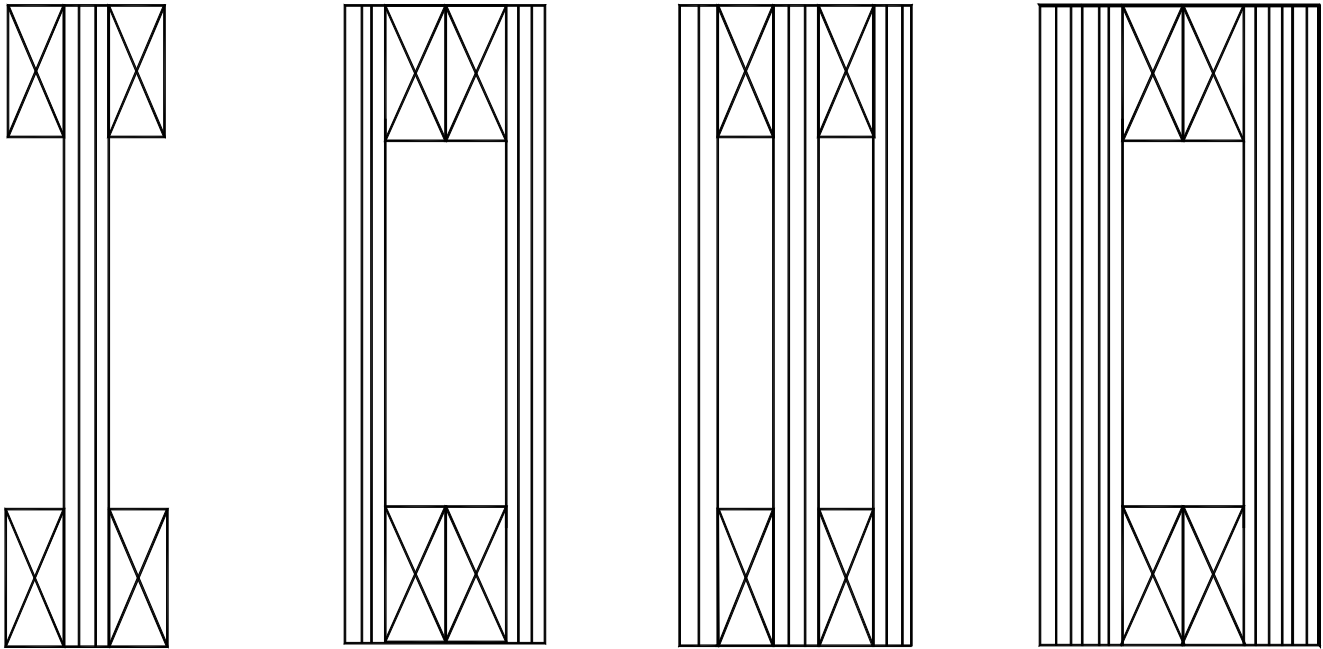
Secciones transversales típicas de las vigas doble T
